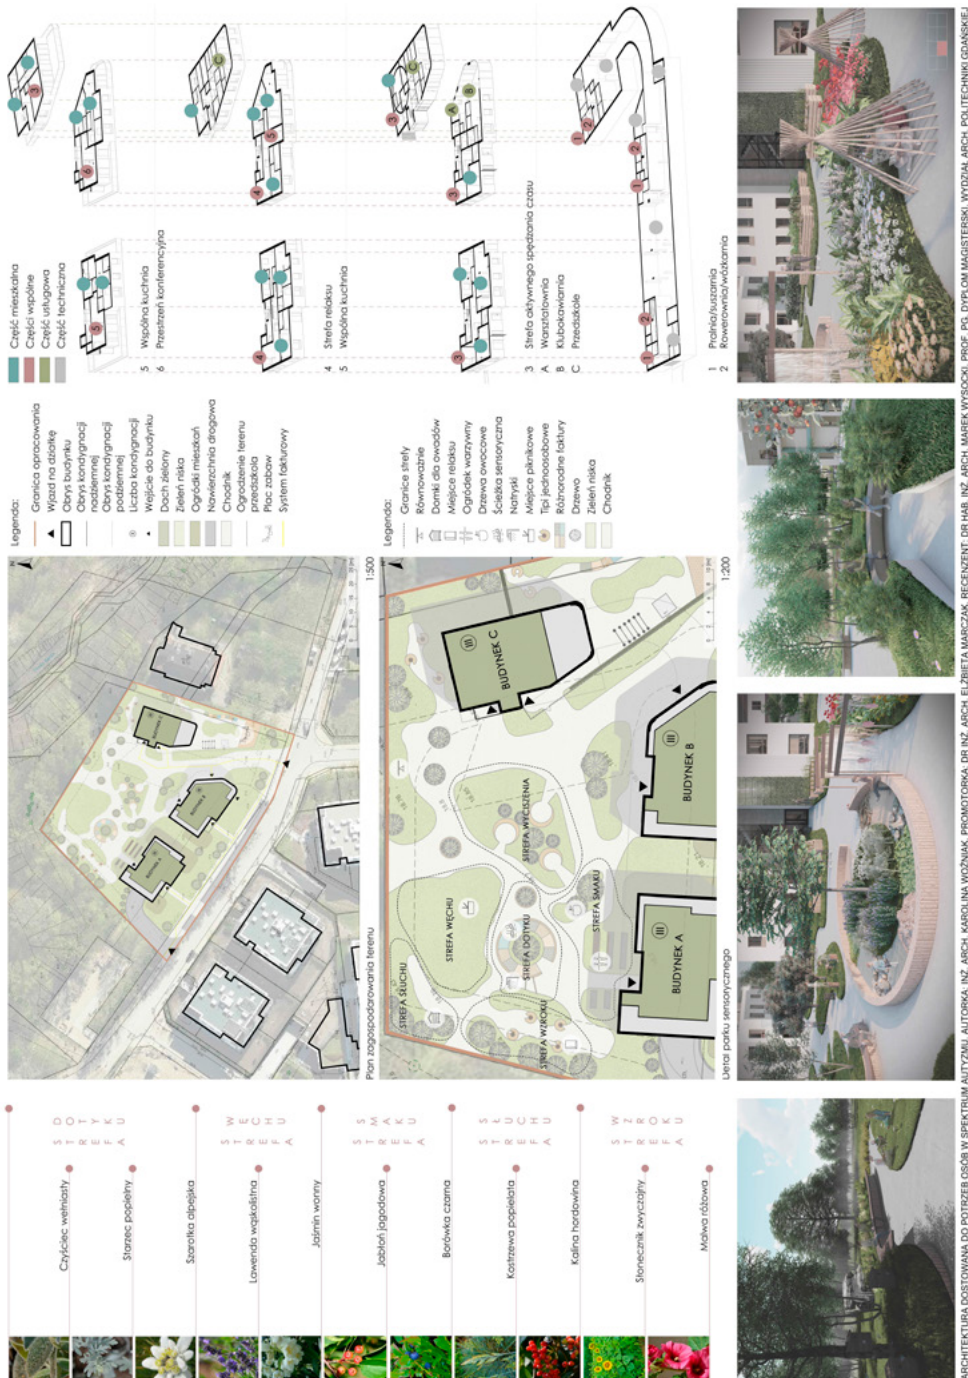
Plansza projektowa nr 2 – opracowanie własne
